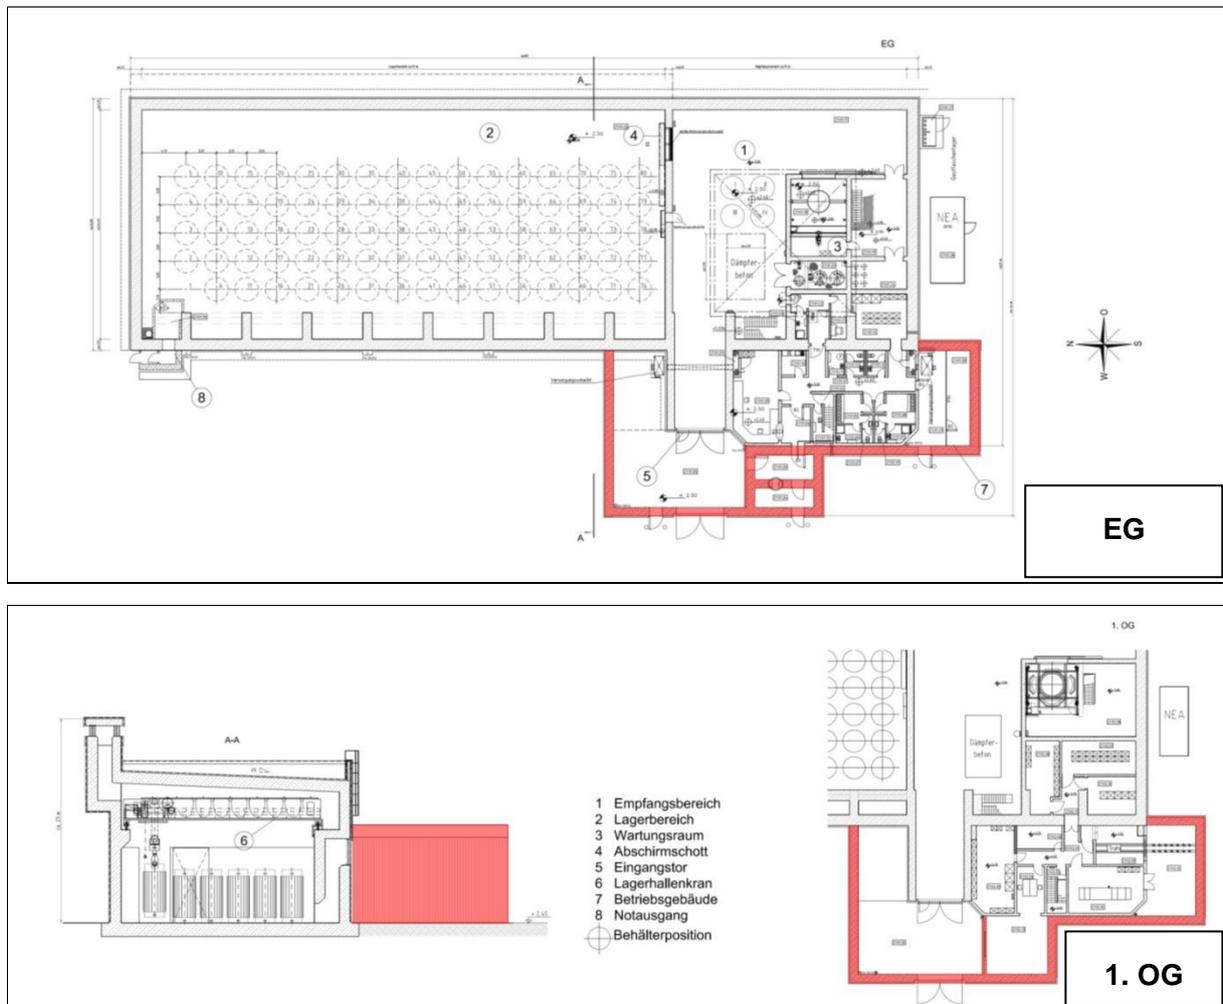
Grundriss und Schnitt durch das Lager- und Betriebsgebäude (KKB 2016)
